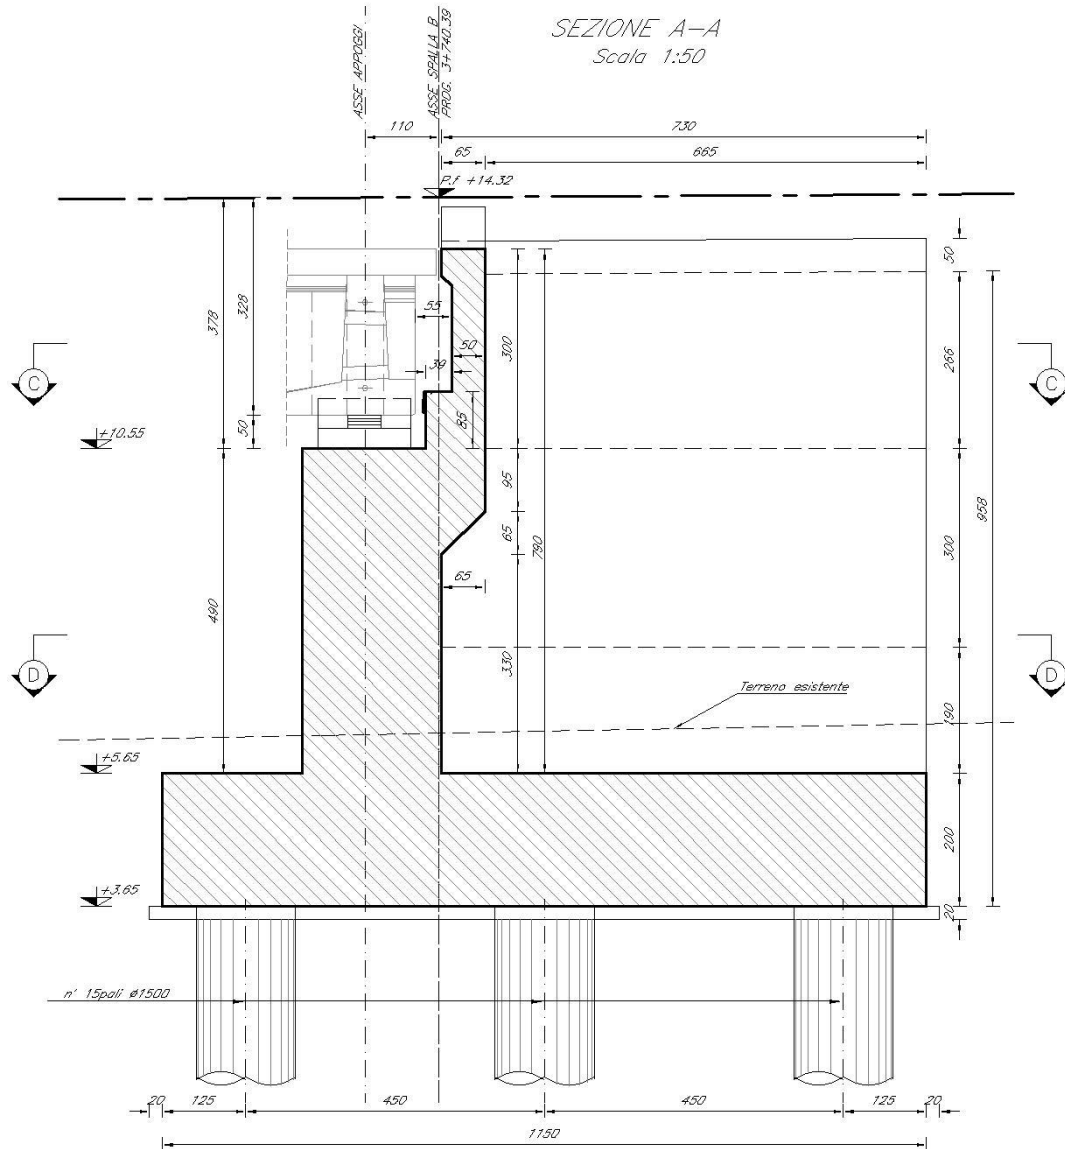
Sezione longitudinale spalla SPB
